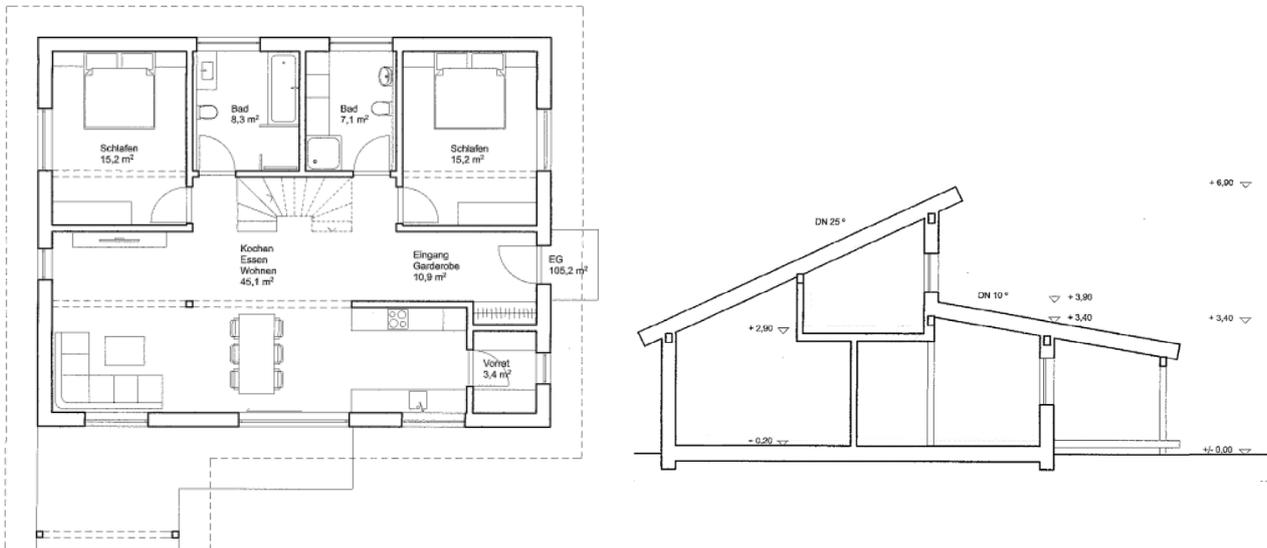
Beispiel Grundriss und Schnitt Seniorenwohnanlage
